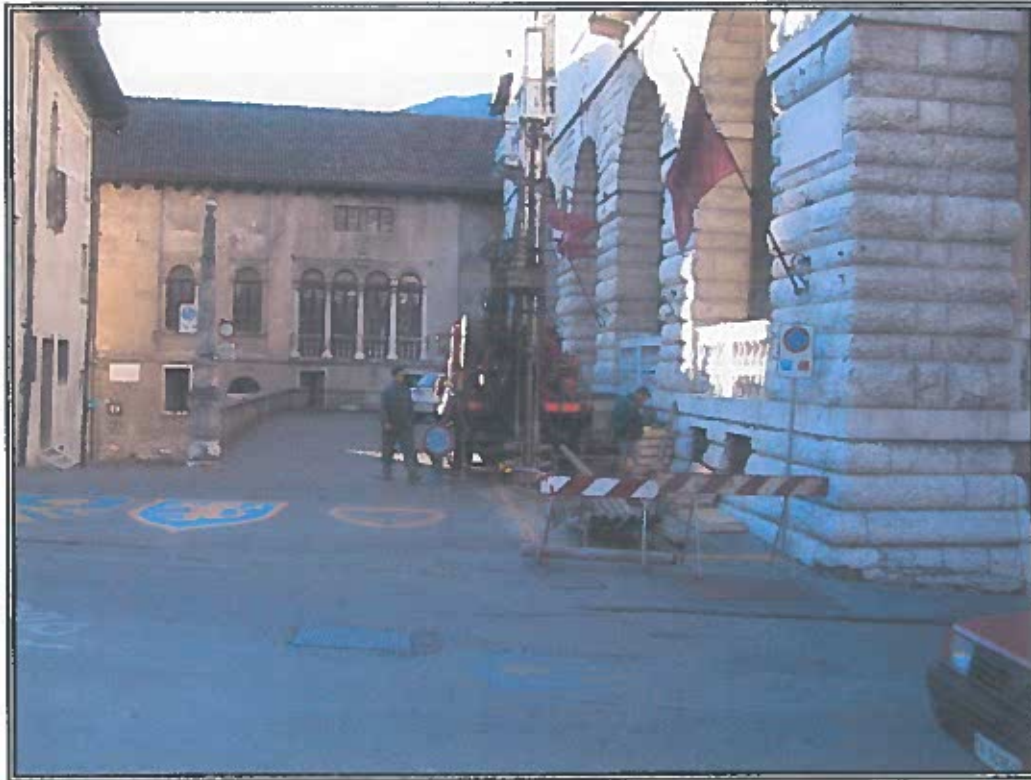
Ubicazione ed esecuzione del sondaggio S1 in piazzetta delle Biade
